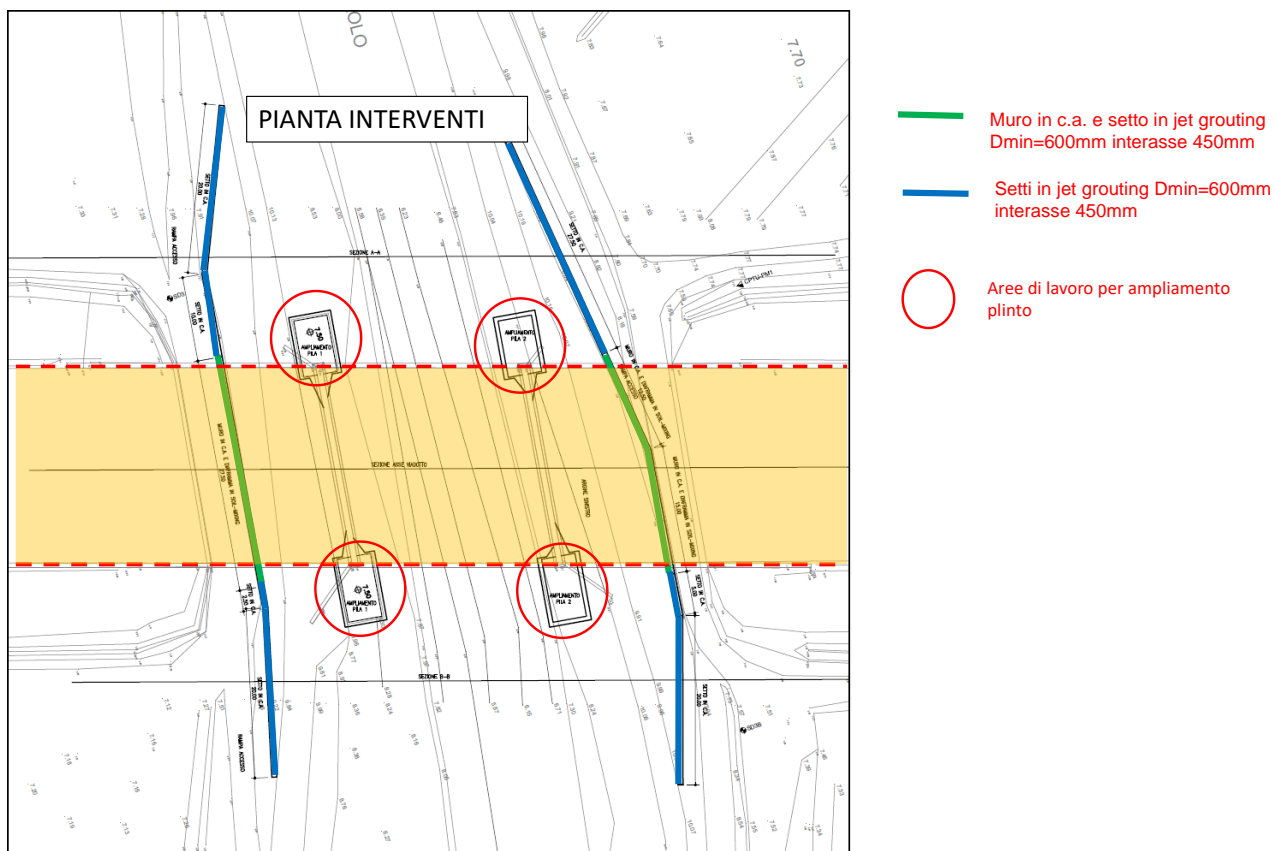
Ponte Canale Bagnarolo – Pianta interventi
